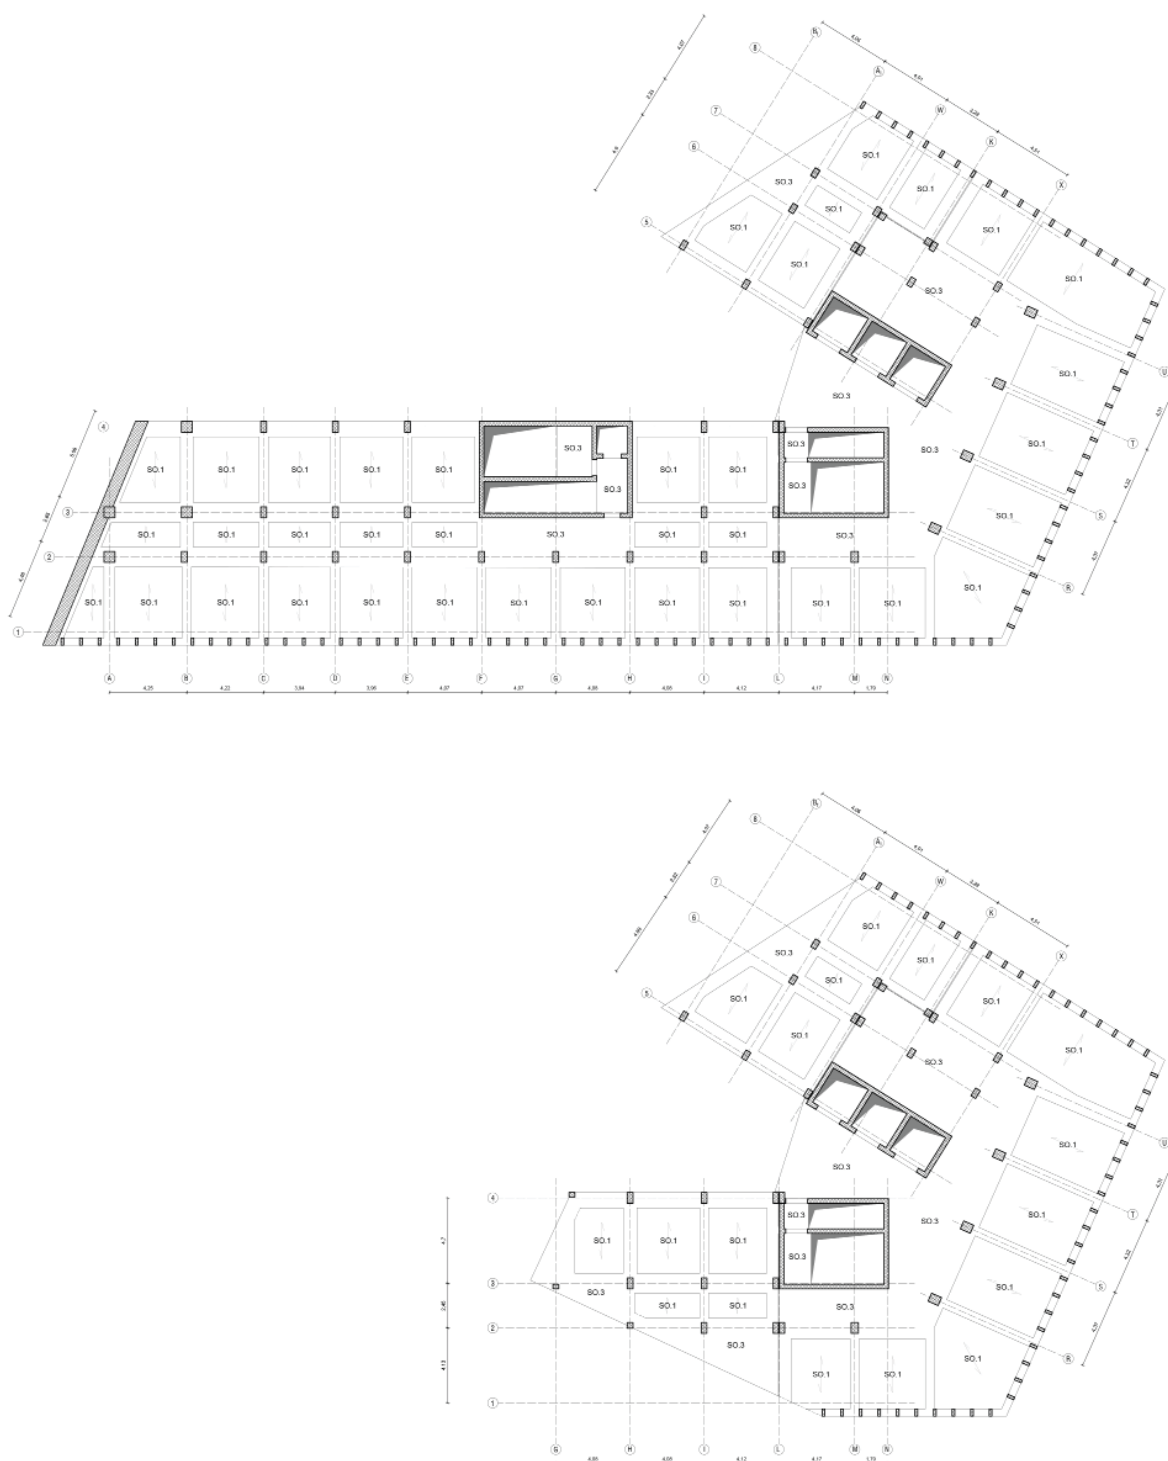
Pianta tipo strutturale impalcati da ottavo a decimo e da undicesimo a dodicesimo
